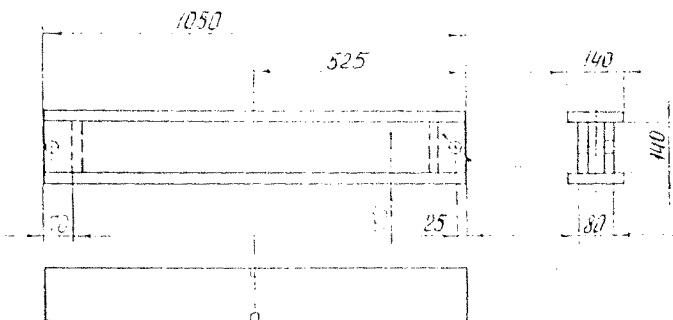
Балочный образец без наплавки сварочных швов
